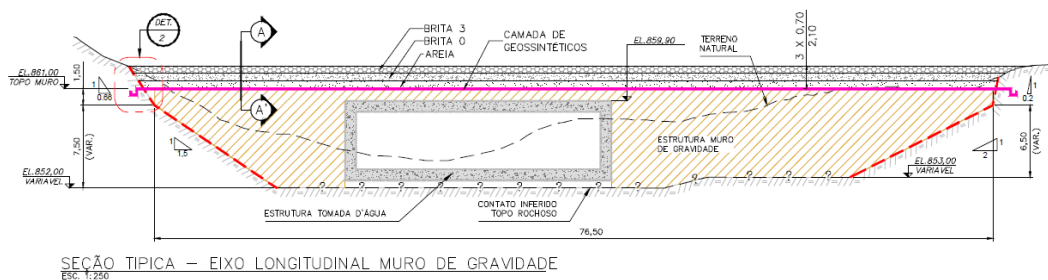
Perfil longitudinal do muro de gravidade (Geoestável, 2019)
